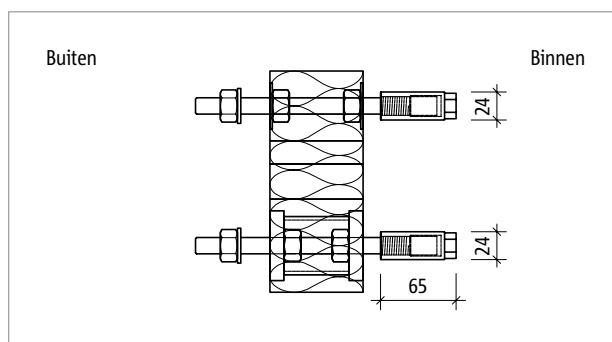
Schöck Isokorb® T type S met beschermende dopmoeren: Vrij uitragende staalconstructie; binnen chloridehoudende atmosfeer
